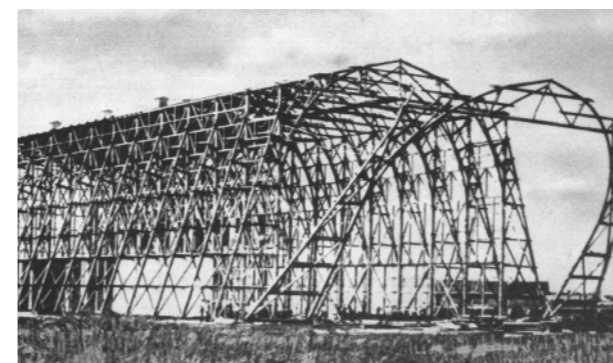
Hölzerne Fachwerkskonstruktion der Staglhalle
